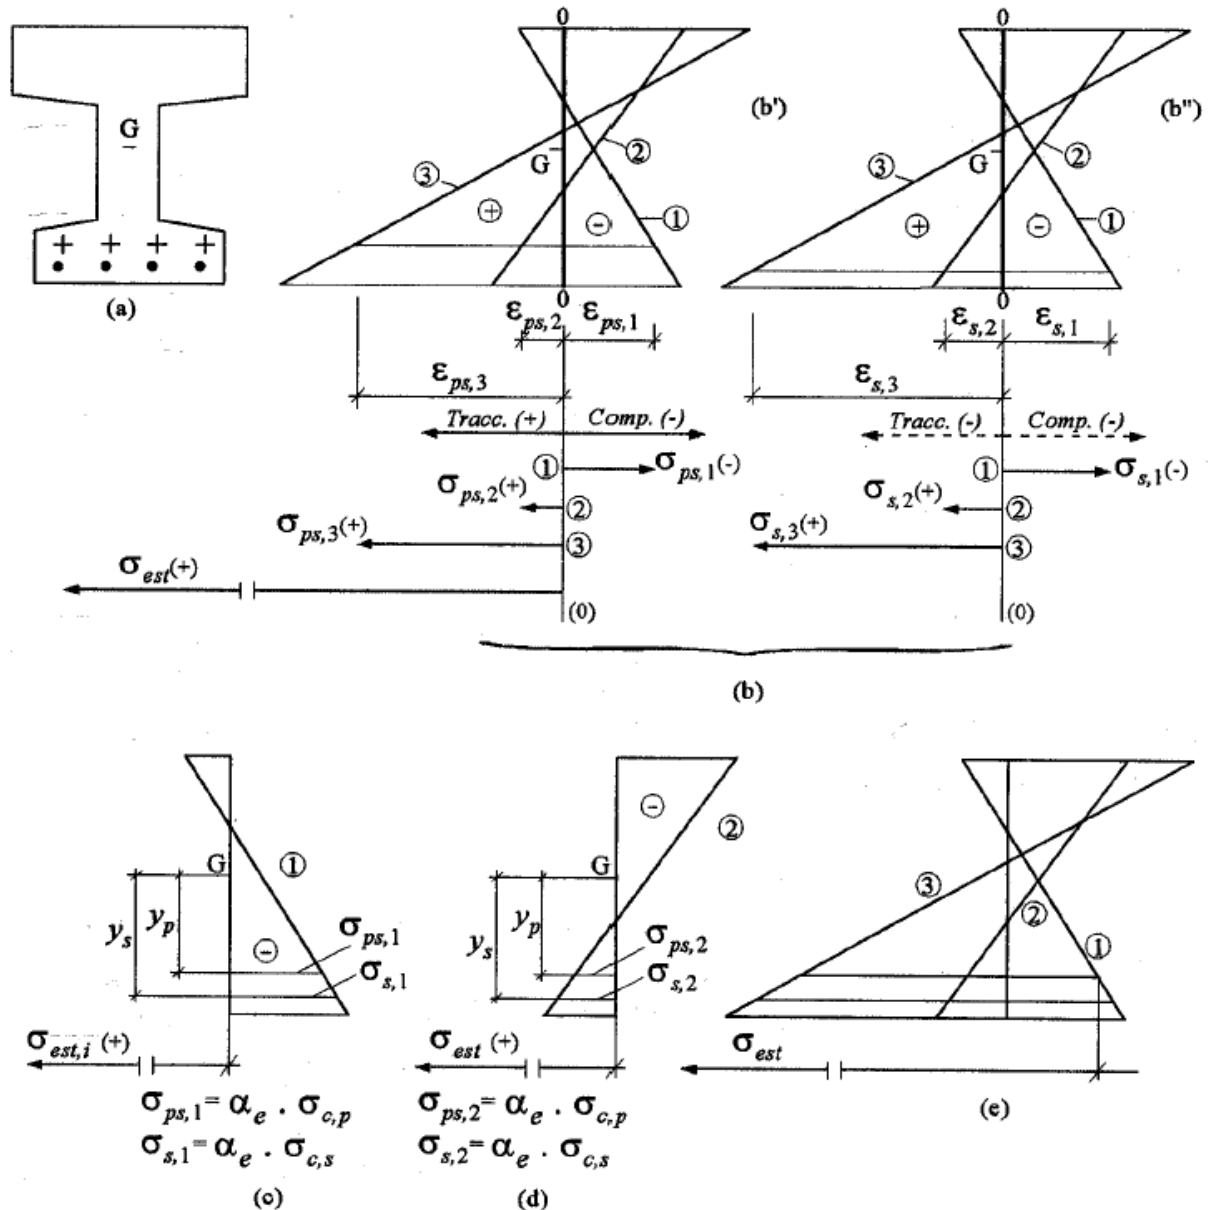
Evaluación aproximada de los incrementos (o decrementos) de tensión sobre las armaduras por la intervención de las cargas exteriores, en régimen de prefisuración.
